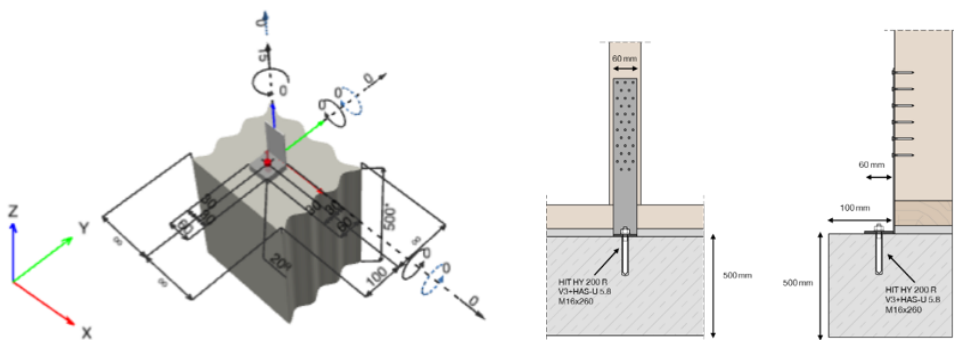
Befestigung einer Holzwand an einer Betonplatte mittels Zugankern: PROFIS Engineering-Modell und Skizze der Anschlussgeometrie
